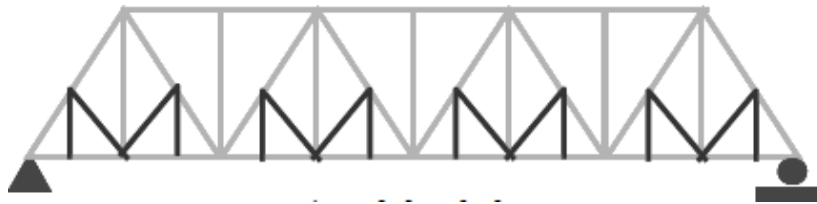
Jembatan Rangka Baja Tipe *Truss Standar
